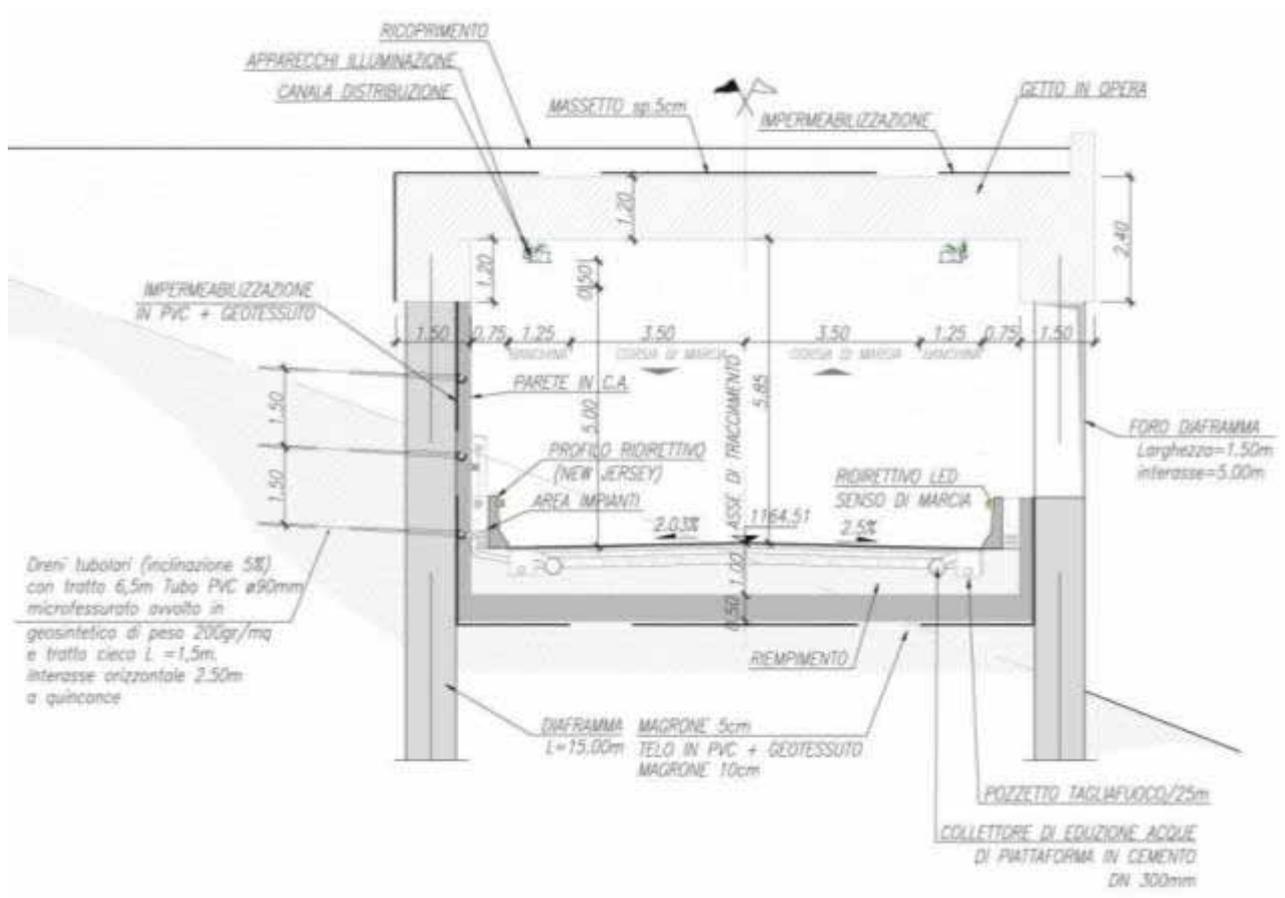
Tratto di galleria aperta (Sezione 08 - ns. elaborazione T01GA010STPF02\_A\_Planimetria, profilo e sezioni tav. 2/2 del progetto definitivo).
